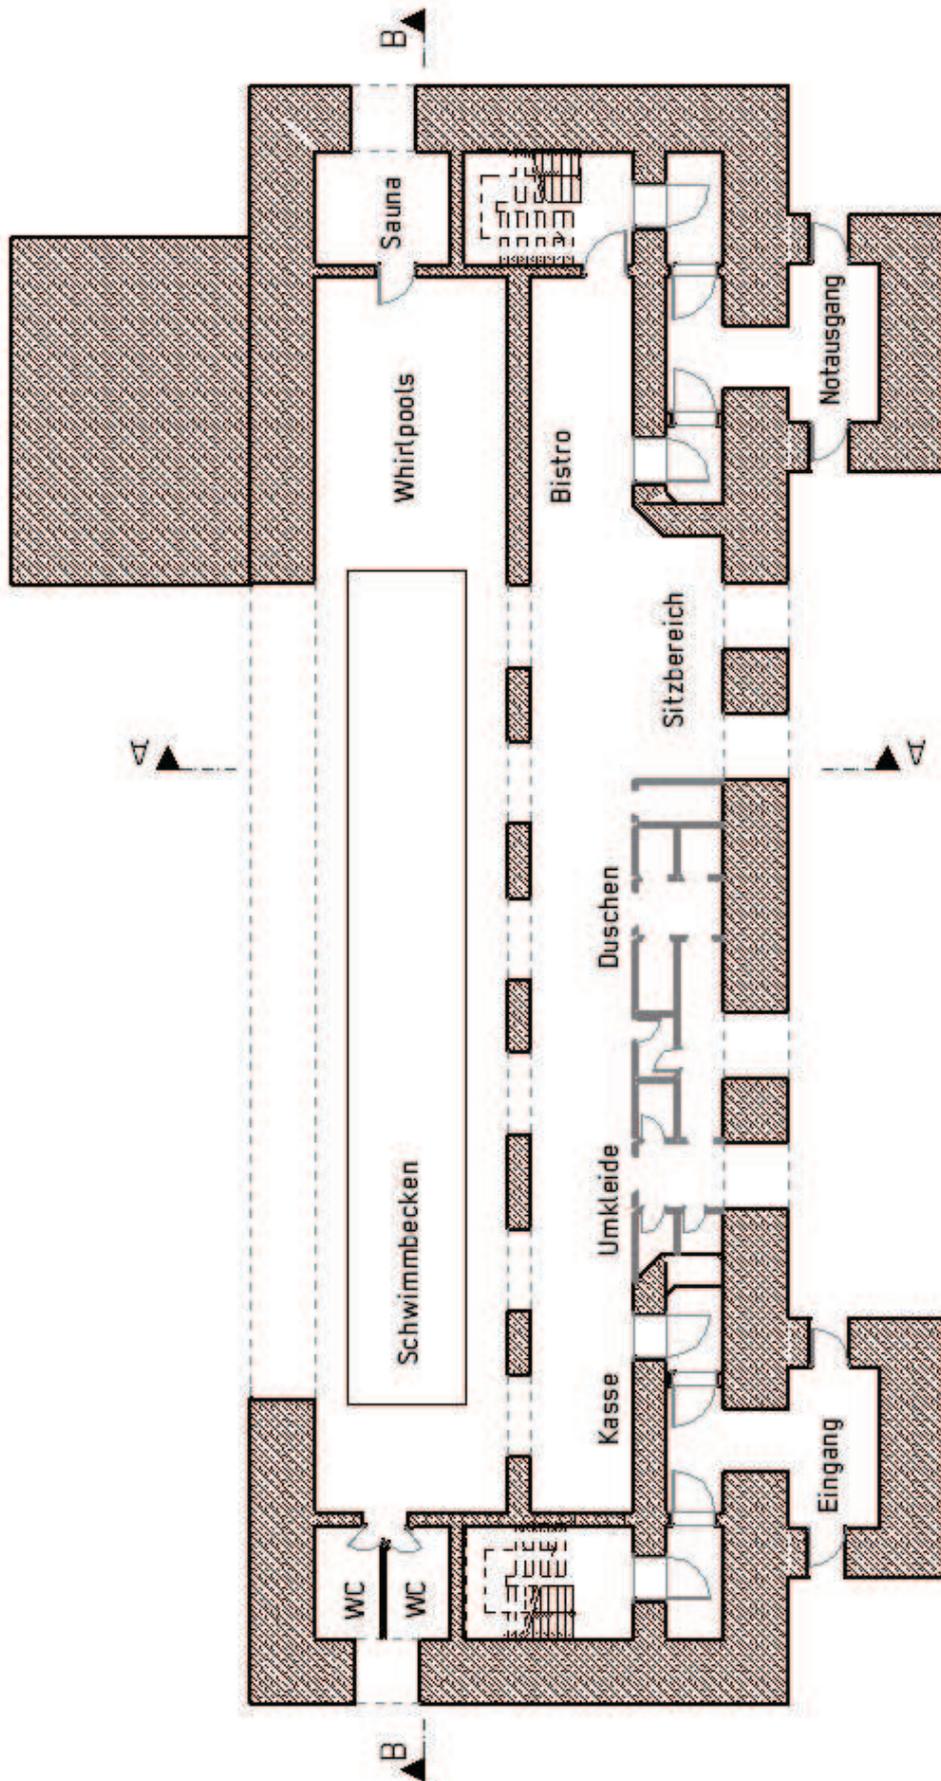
, Grundriss Erdgeschoss
